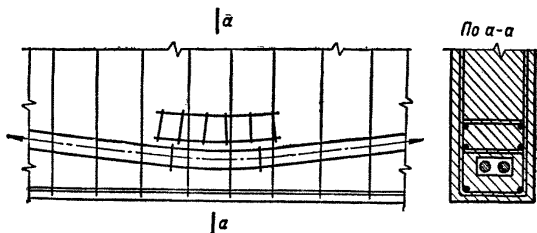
Усиление бетона дополнительным армированием в местах перегиба напрягаемой арматуры
